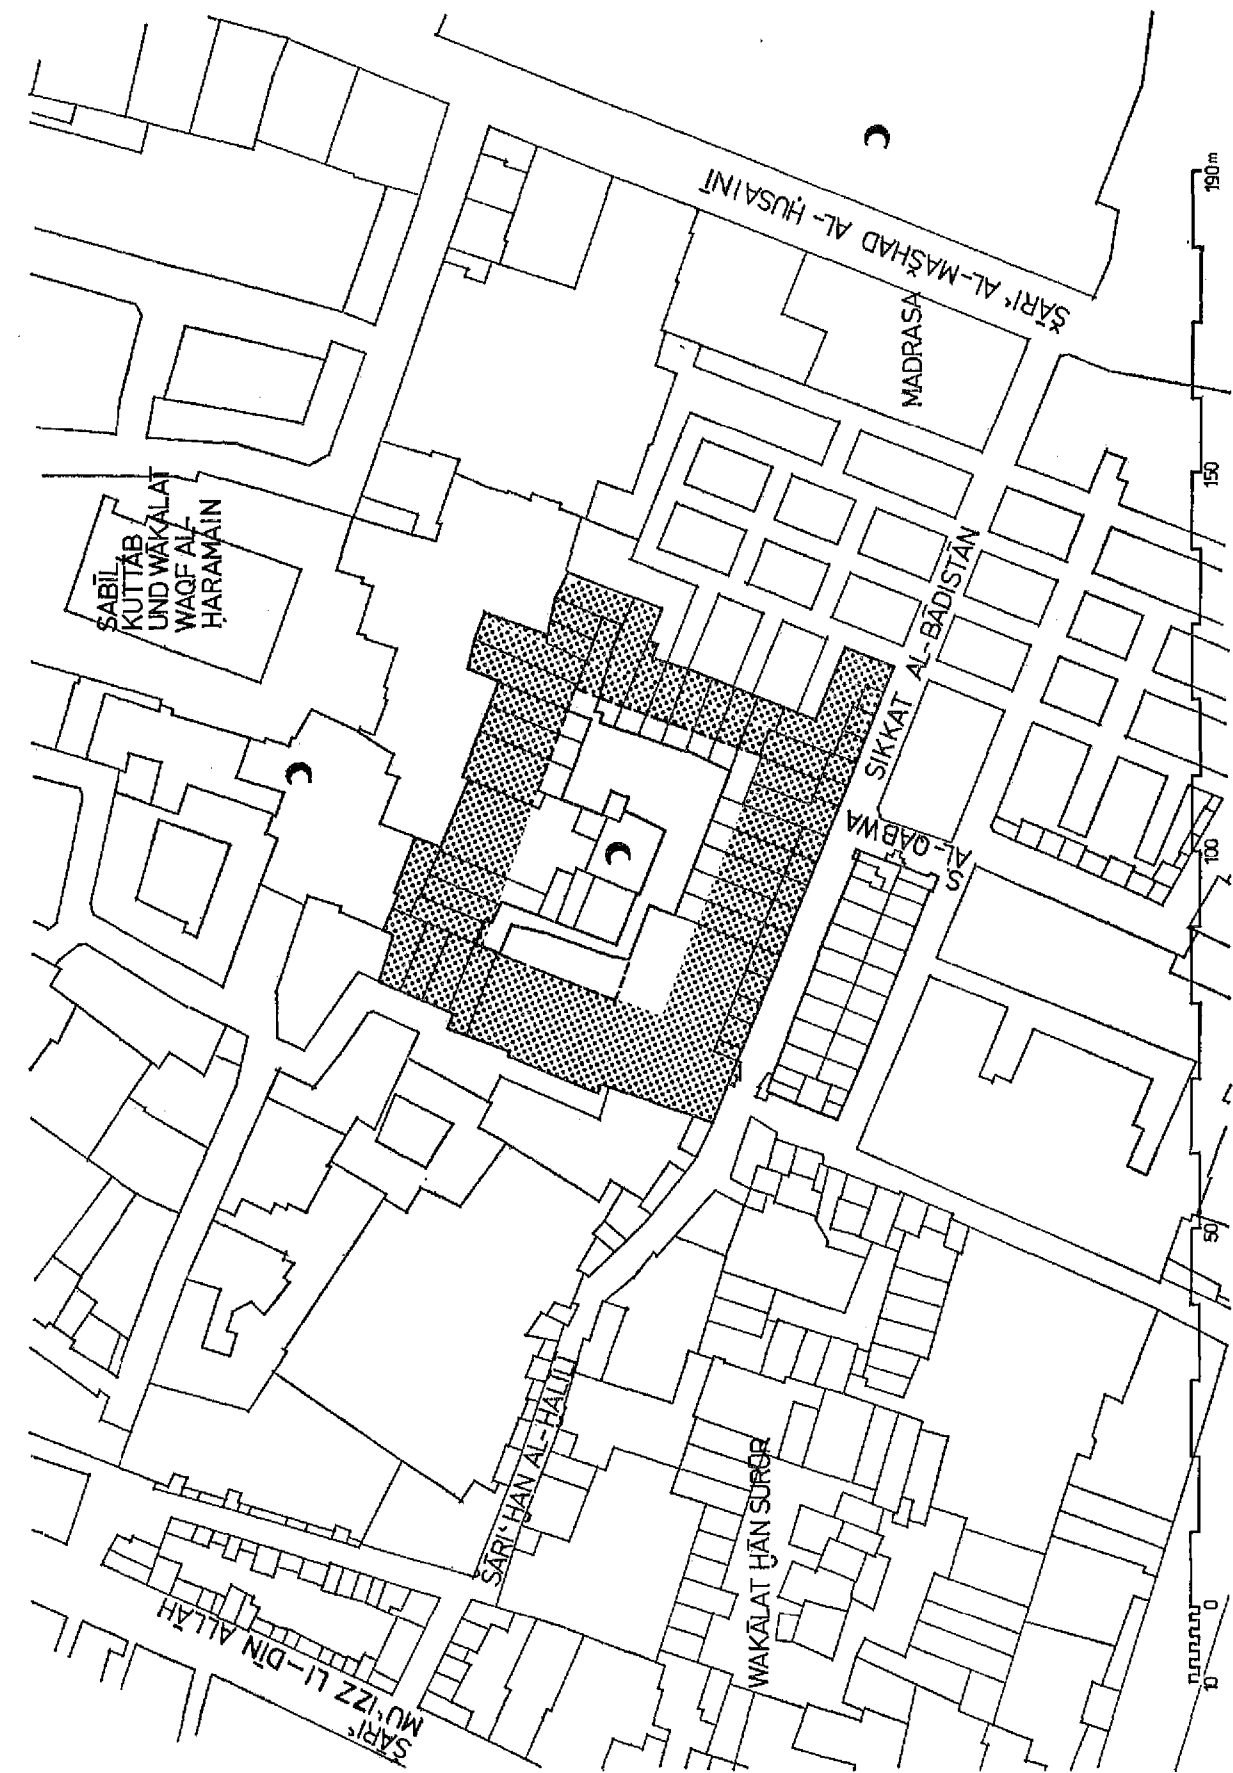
Kairo, Wakālat al-Quṭn, Lageplan
